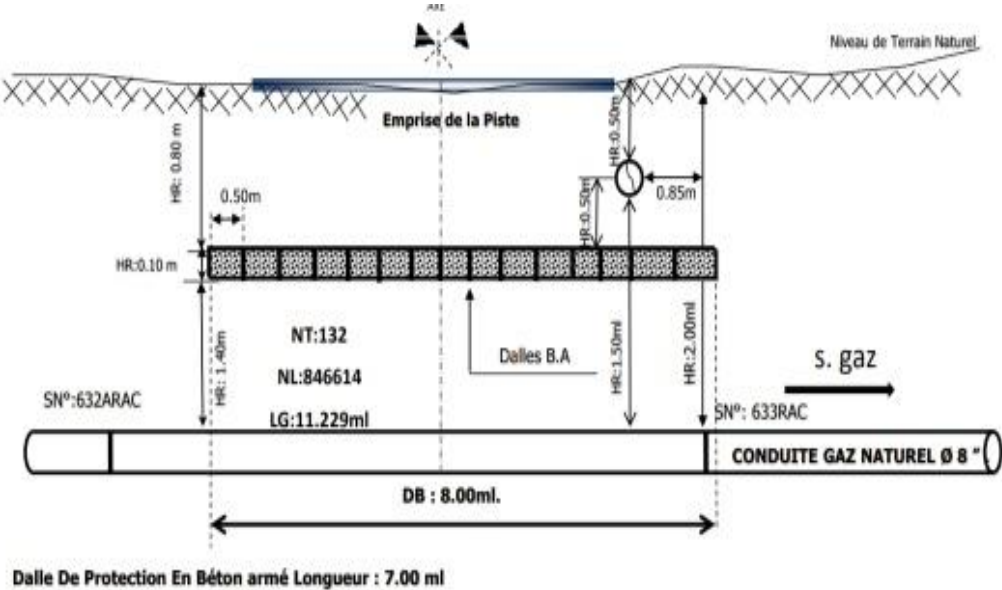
Croquis de croisement de gazoduc avec conduite d'eau et piste forestière.
